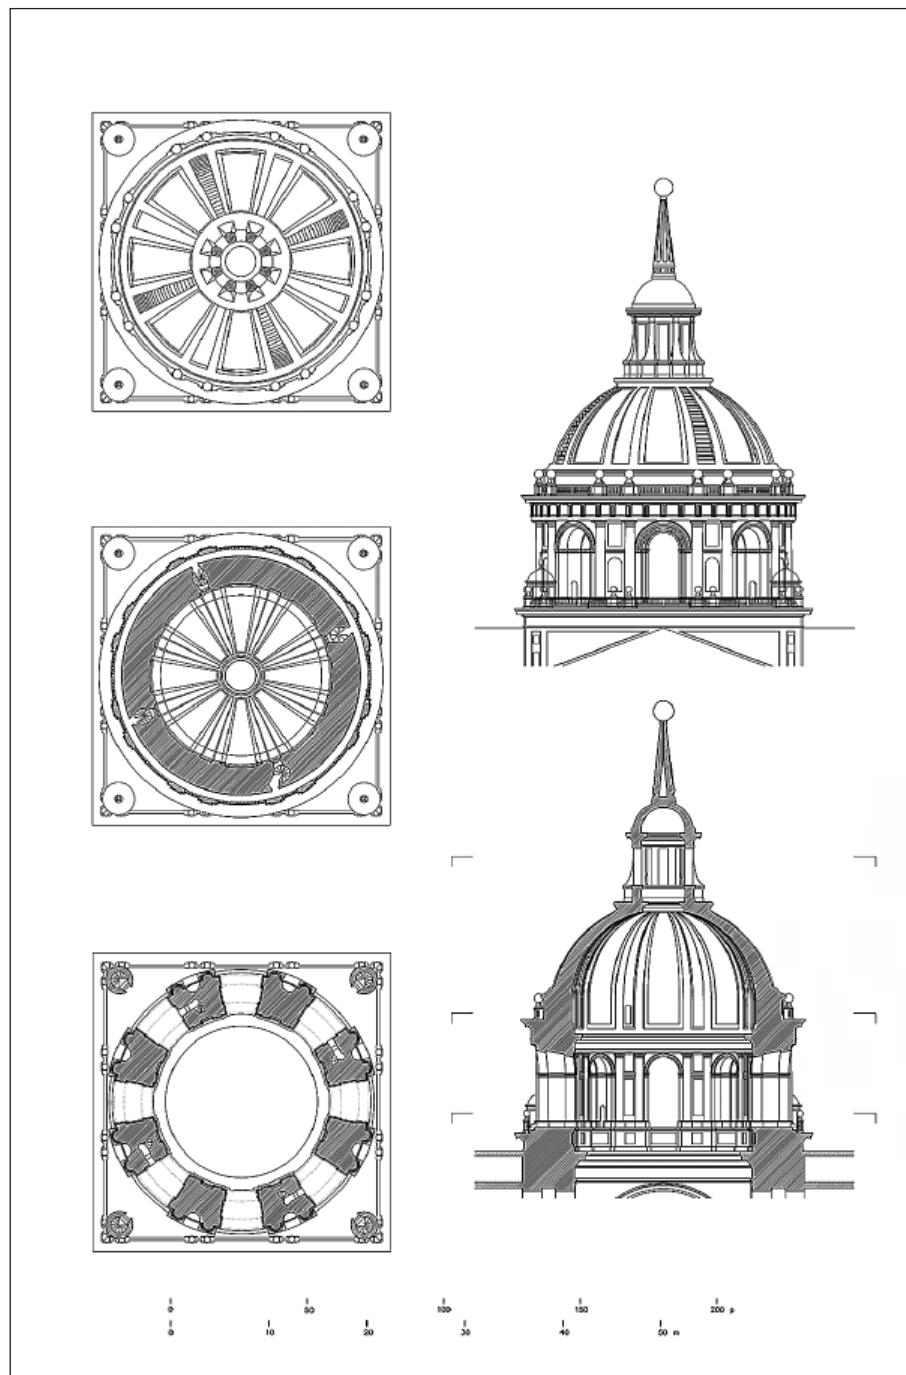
Plantas, alzado y sección de la cúpula de El Escorial (Ana López Mozo).
